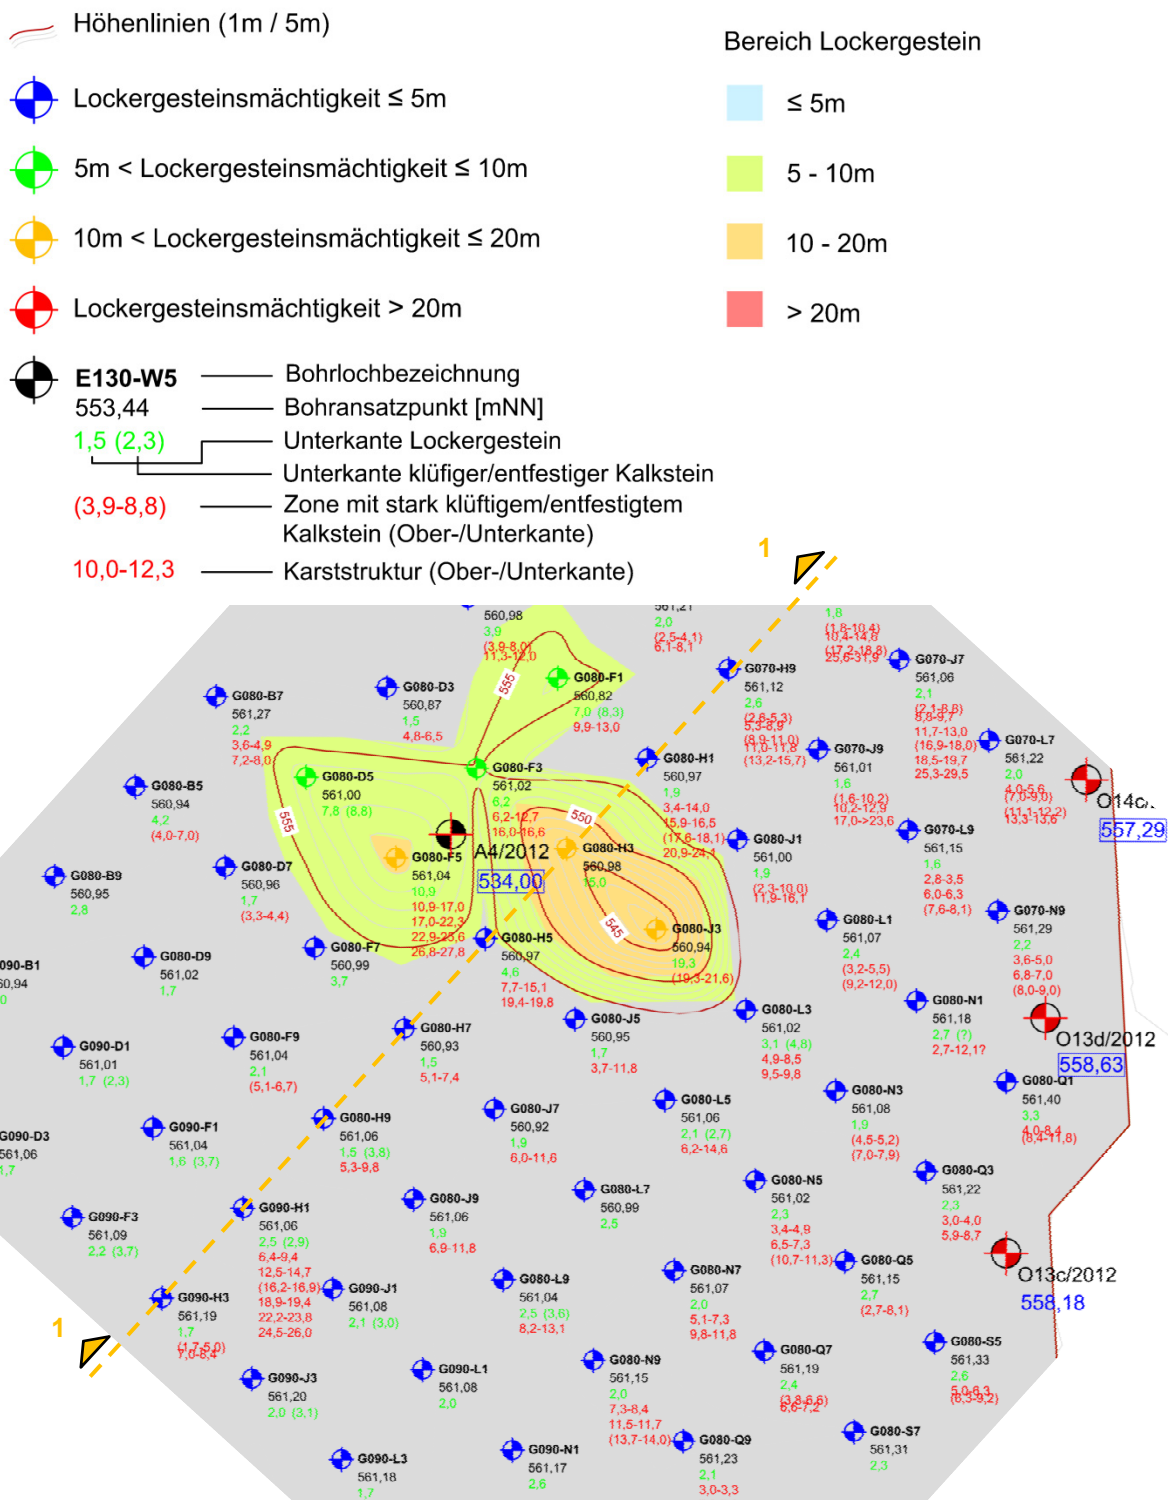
Zeichnerische Darstellung der Auswertung und Bewertung der Ergebnisse der Vollbohrungen im Grundriss (Ausschnitt Teilfläche)
